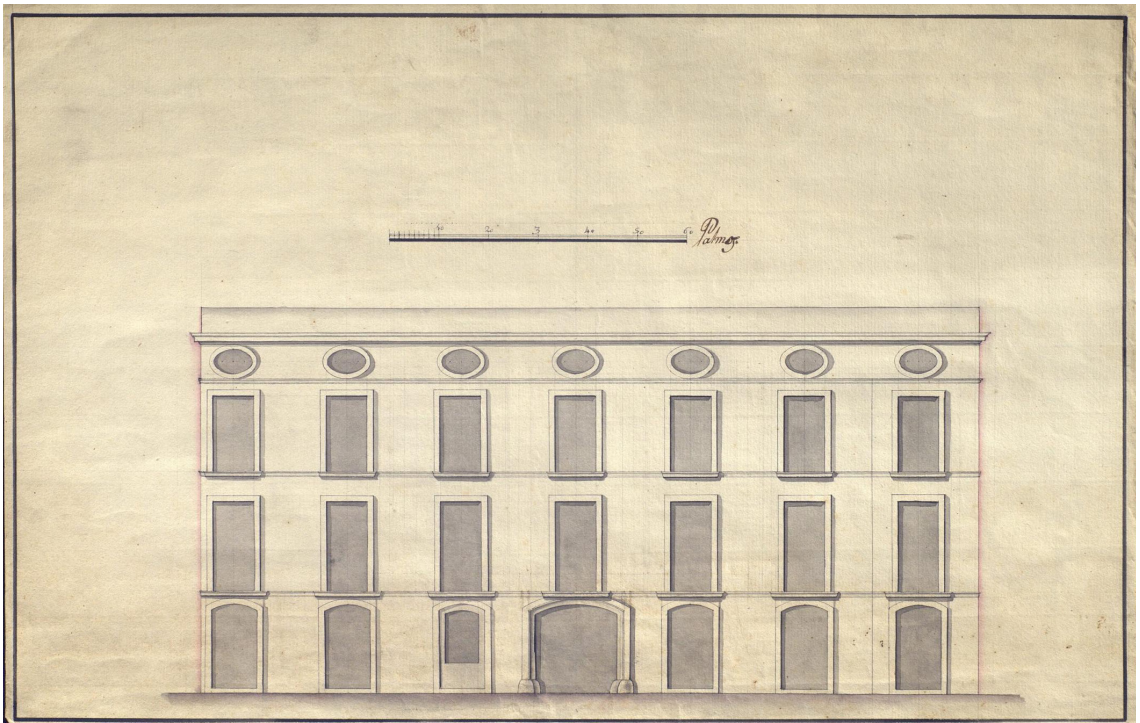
Alzado de la fachada del *primer* proyecto de reforma de la Casa Dou. AHCB.
